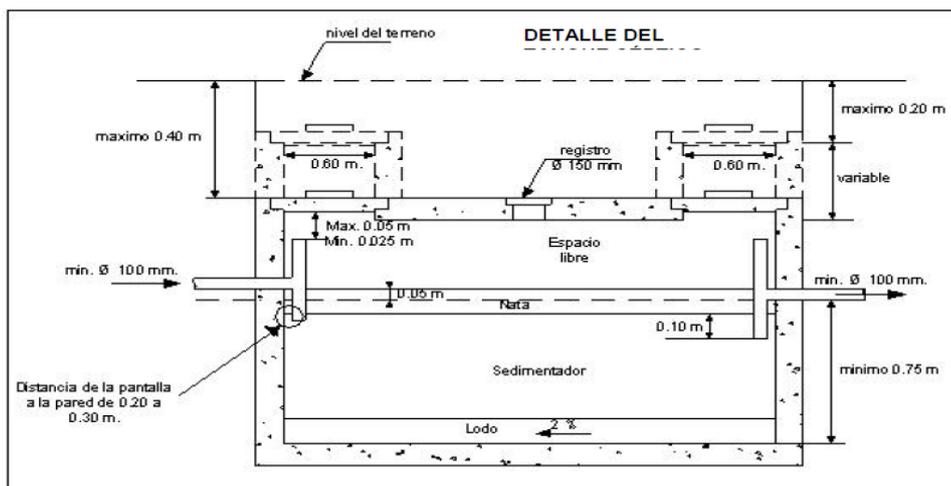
Especificaciones Técnicas para el diseño del tanque séptico.
